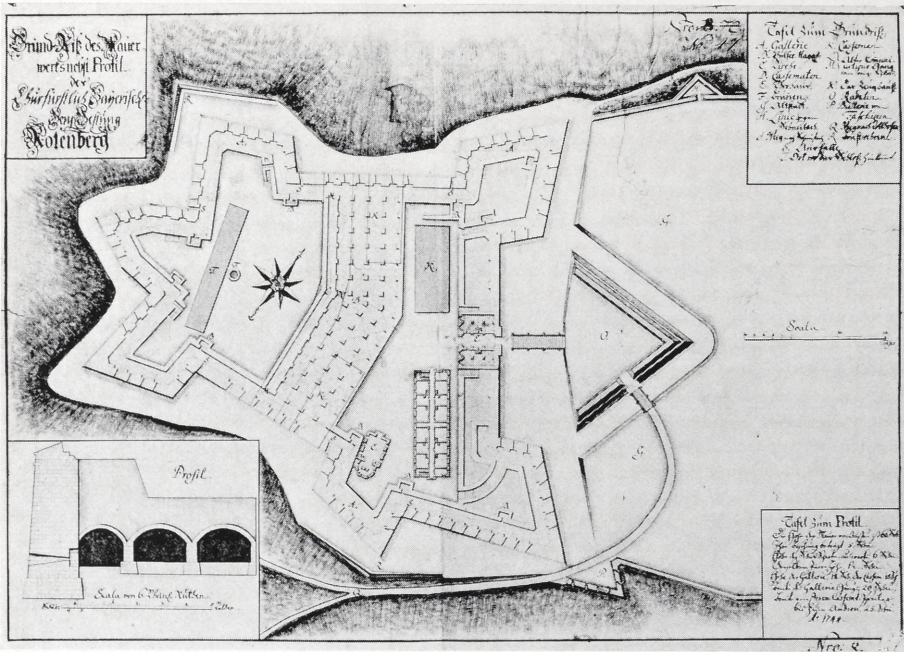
Festung Rothenberg, Lageplan vom Jahre 1744
